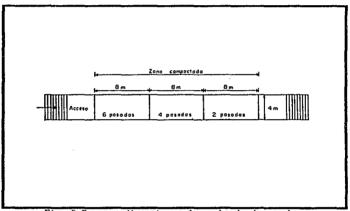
Rampa y dimensiones de un bordo de prueba.
